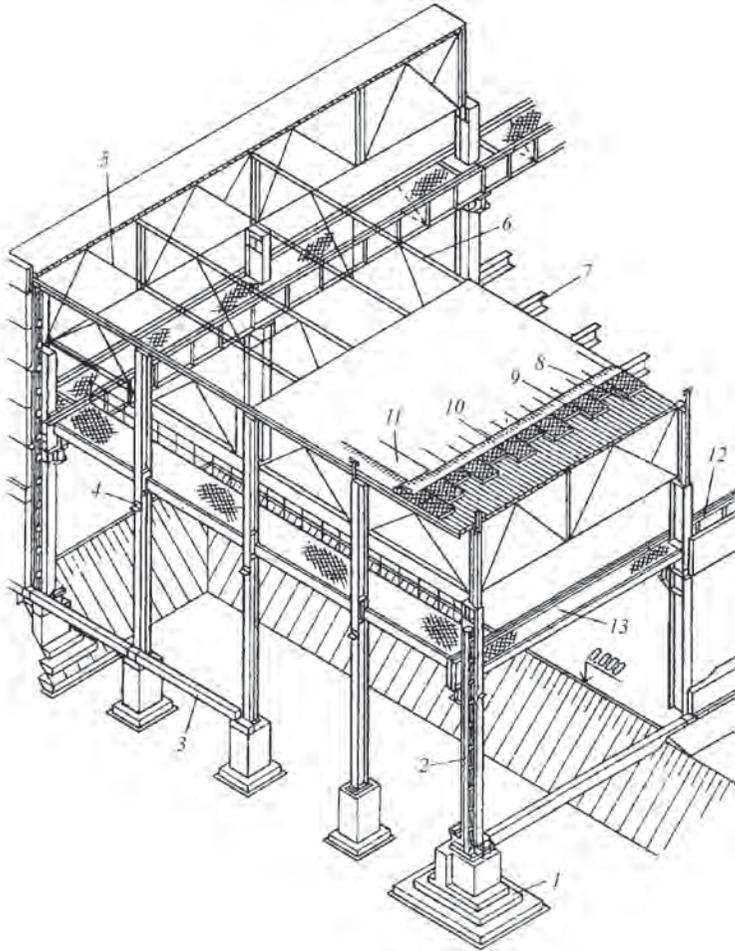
Стальной каркас со стропильными и подстропильными фермами: 1 – фундамент; 2 – колонна; 3 – фундаментная балка; 4 – стойка фахверка; 5 – подстропильная ферма; 6 – стропильная ферма; 7 – прогоны; 8 – профилированный настил; 9 – утеплитель на пароизоляции; 10 – стяжка; 11 – ковровый ковер; 12 – подкрановая балка; 13 – ходовой мостик
